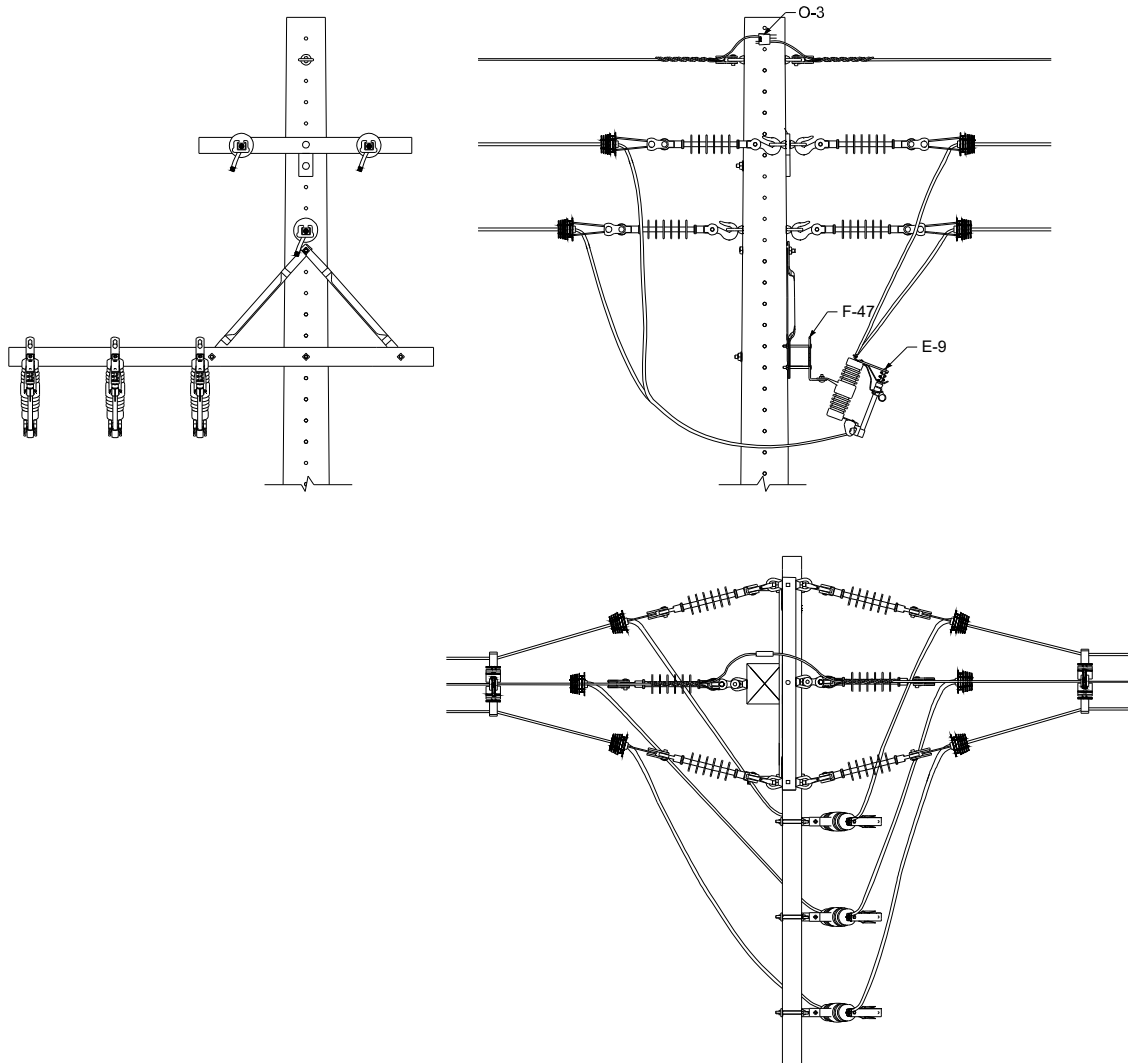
Instalação de equipamento – Chave fusível – Seccionamento – Estrutura trifásica – Suporte horizontal
